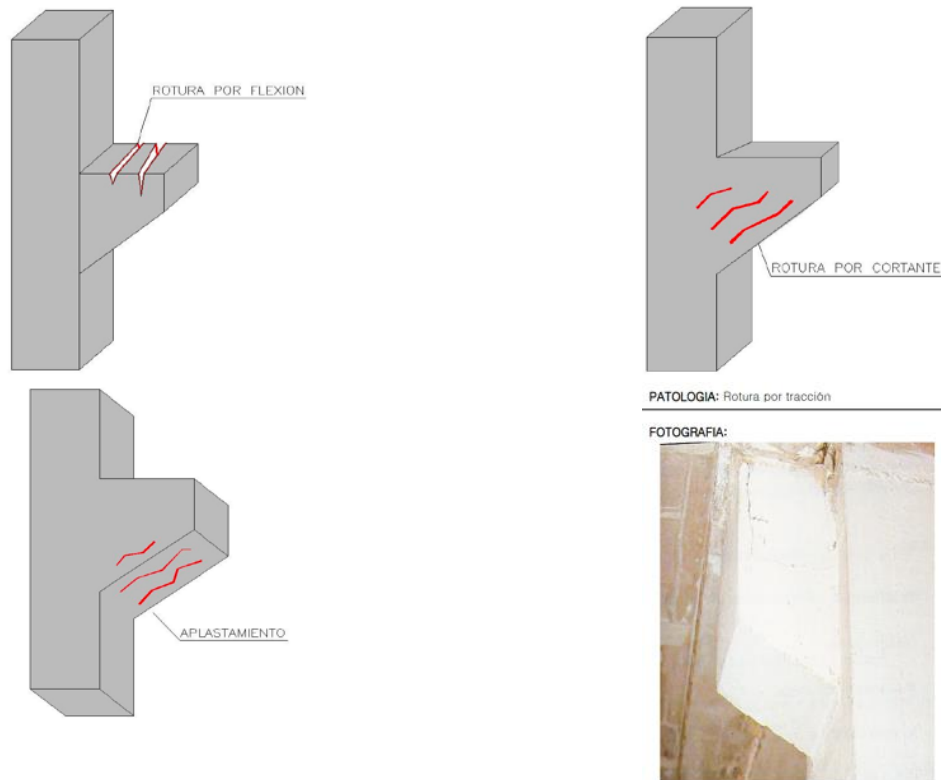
Posibles patologías en ménsulas. Tomada de Catálogo de Patologías de las estructuras de hormigón armado (2005).
